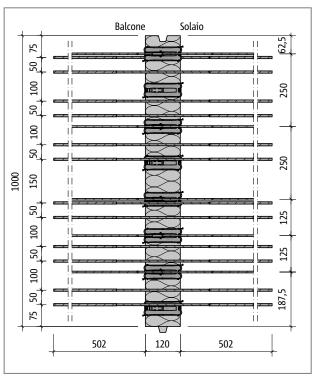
Schöck Isokorb® tipo KXT45, KXT50: sezione dell'elemento
